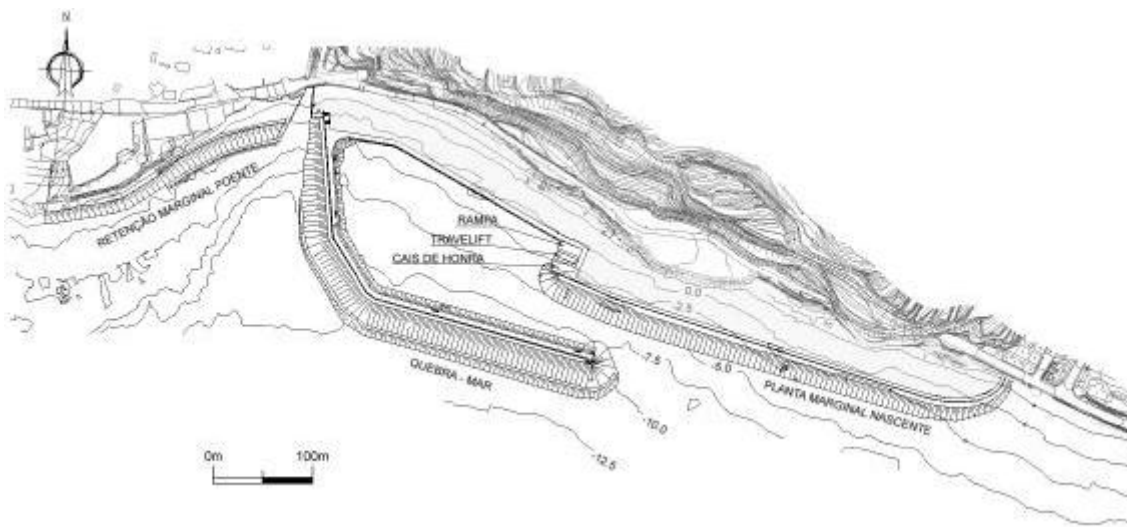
Planta geral da marina do Lugar de Baixo. [1]
